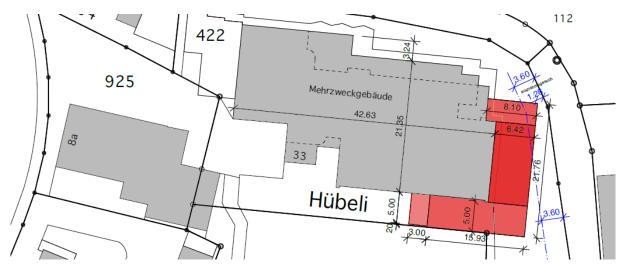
Ausschnitt Situationsplan Vorprojekt 2021
